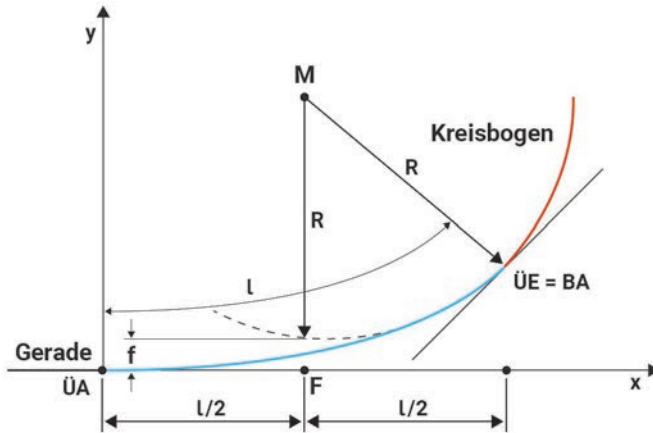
Darstellung einer Klothoide als Übergangsbogen im Grundriss
